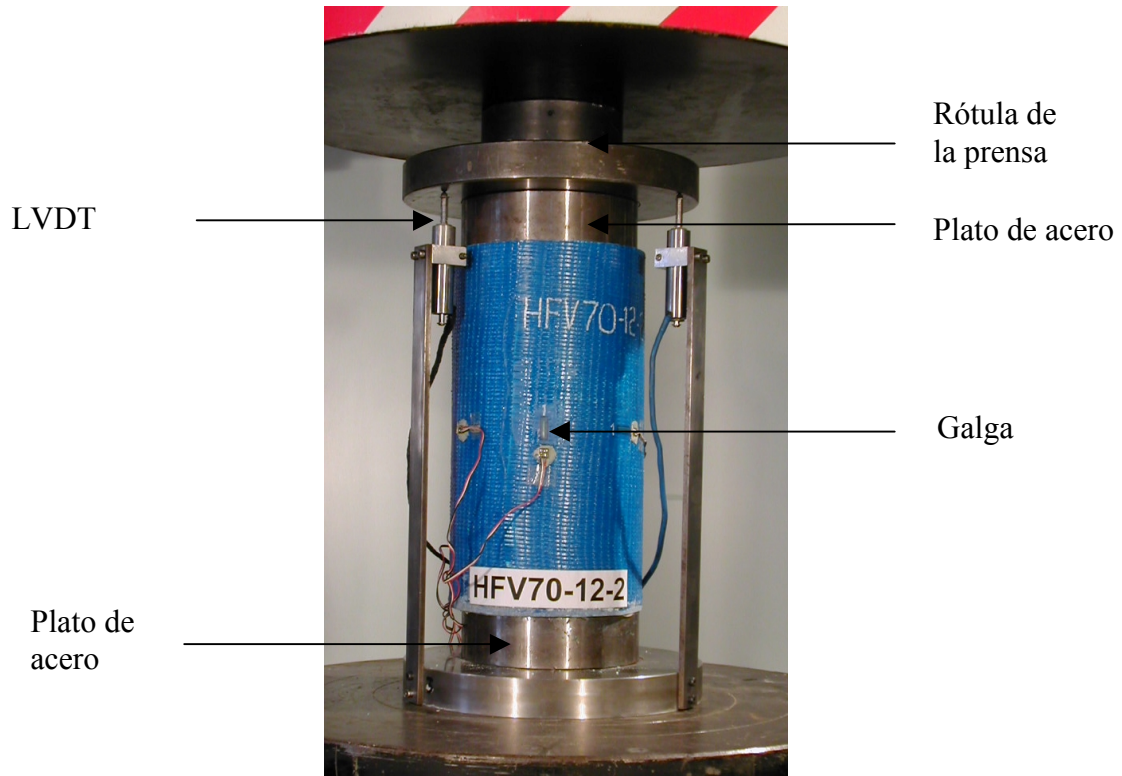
Instrumentación de probetas para ensayo de hormigón confinado con polímeros reforzados con fibra
